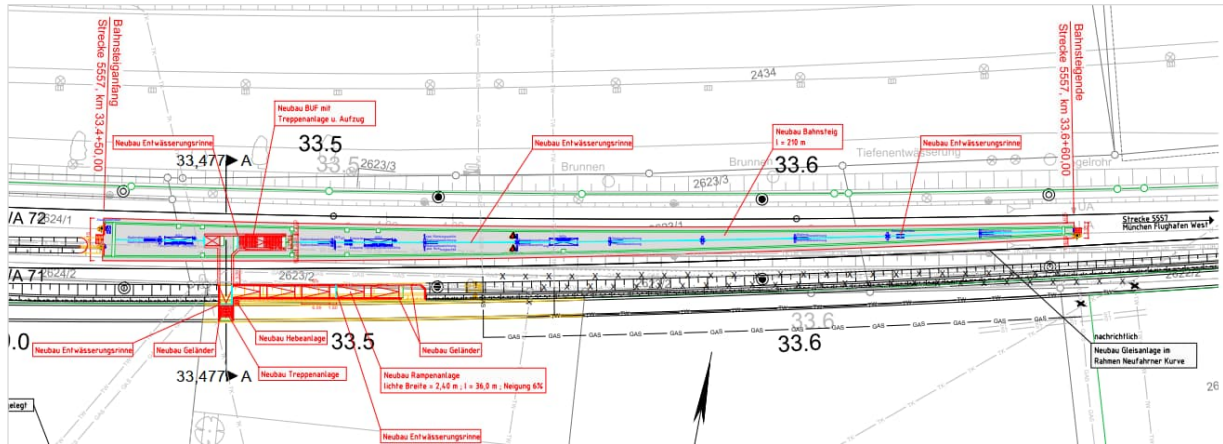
Lageplan S-Bahnhalte Mintraching (Quelle: Vorentwurfsplanung Pöyry, Stand: 18.12.2014)
